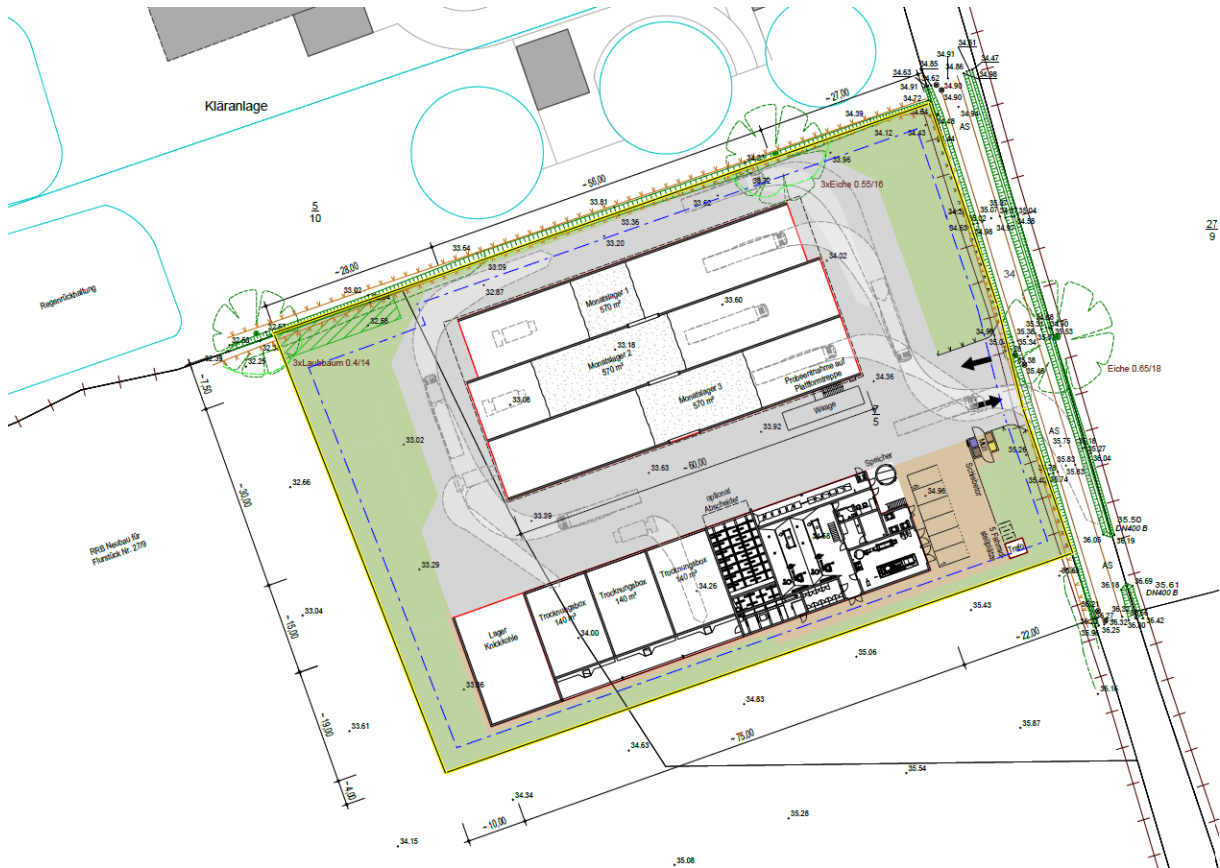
Lageplan des geplanten Holzkraftwerkes
